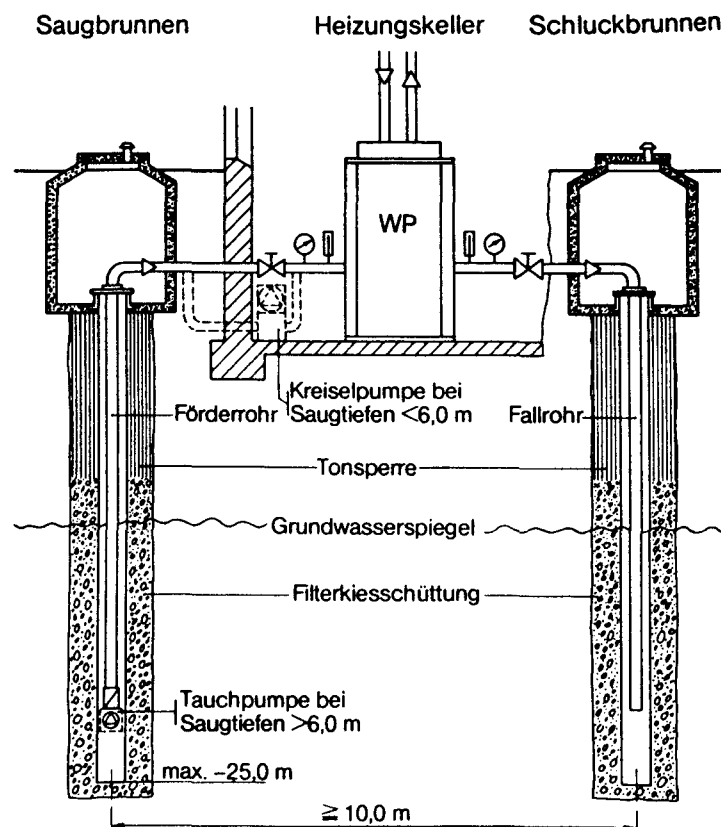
Schema einer Grundwasserwärmepumpenanlage /4.42/
